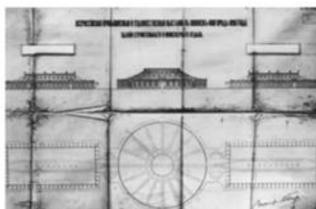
Ротонда и прямоугольные здания строительного и инженерного отдела с деревянными покрытиями
